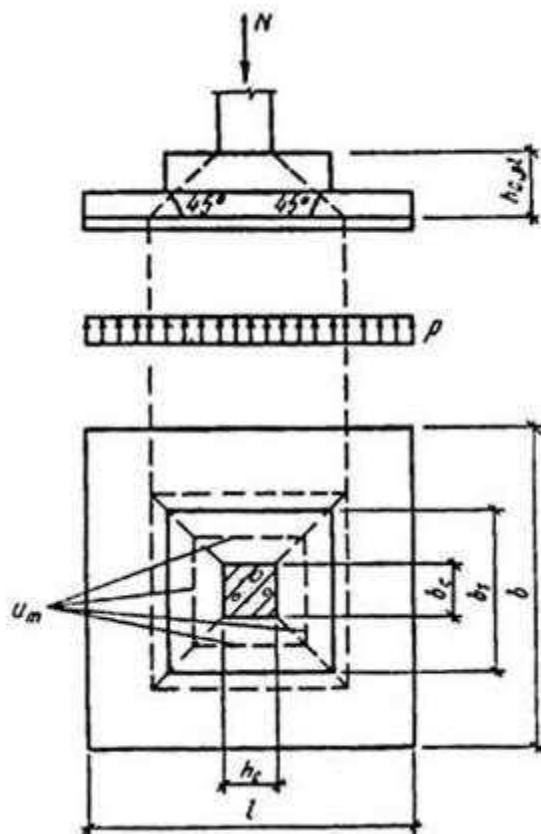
Схема образования пирамиды продавливания в центрально-нагруженных квадратных железобетонных фундаментах
